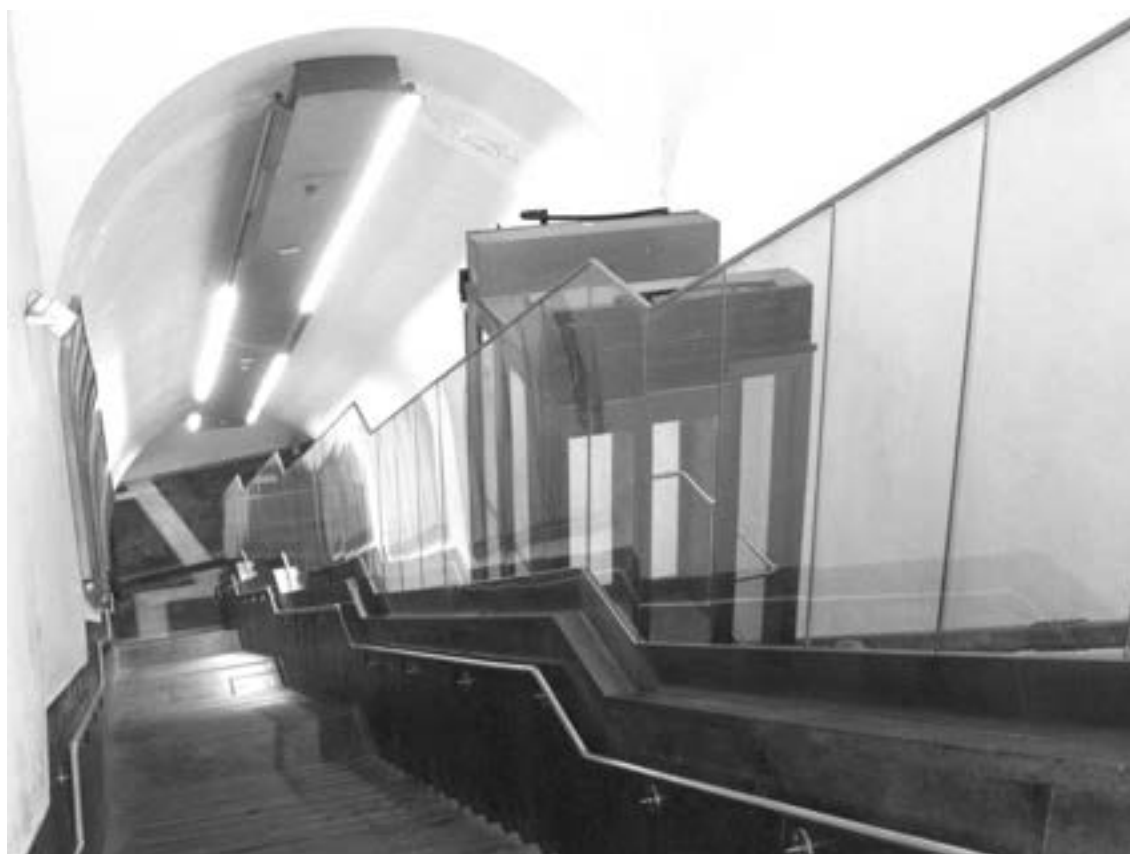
Esempi di impianti elevatori tecnologicamente avanzati:
